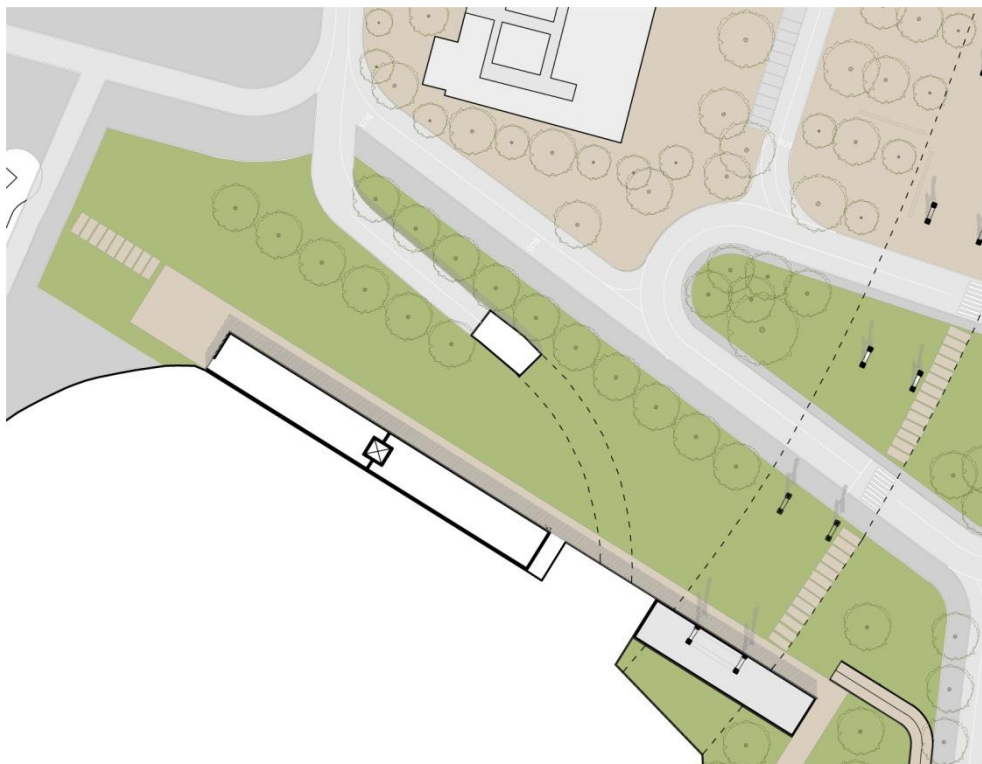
39 – Planta Térrea do ISCA. Fonte: IA.
